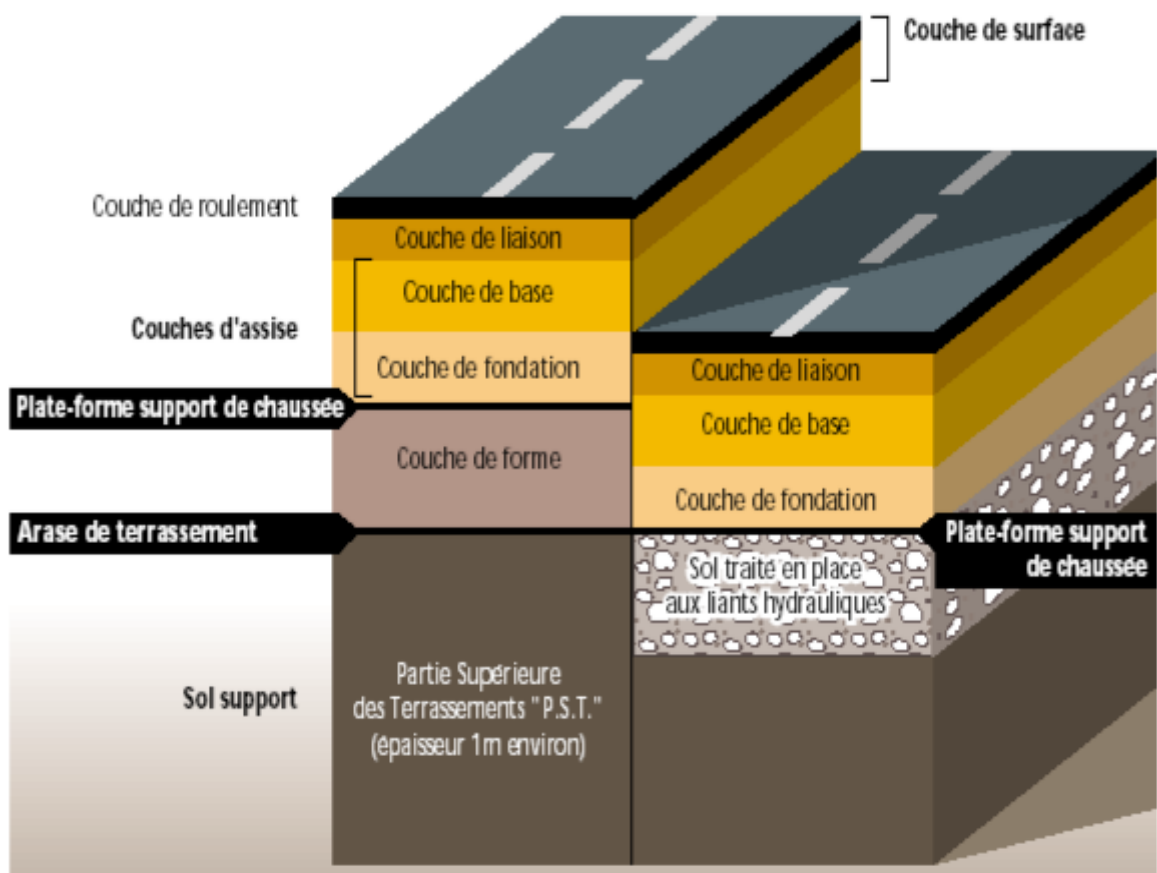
les différentes couches d'une chaussée [Visa, 2008]
